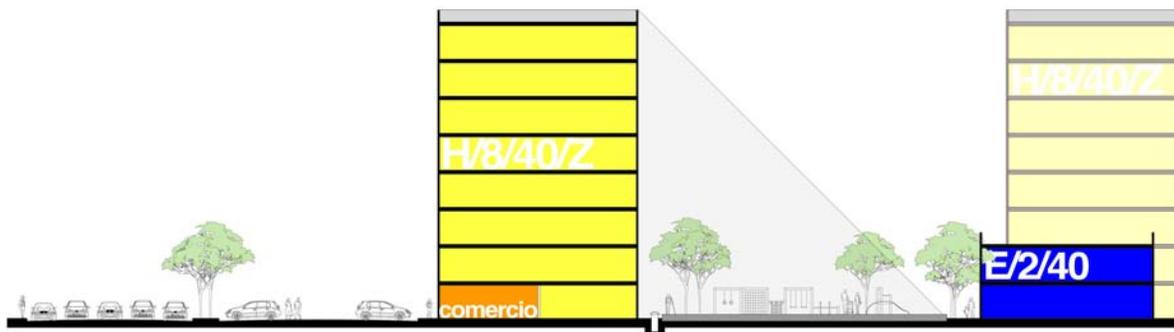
Sección tipo en la zona central de Tlatelolco. Fuente: Estudio de campo del autor.
